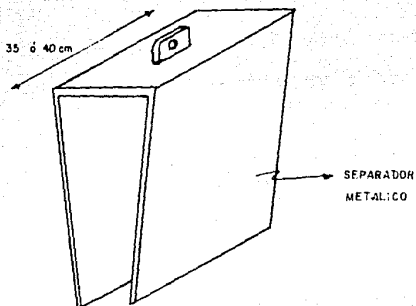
Ejemplo de placa guía en Molde Autopresforzante
